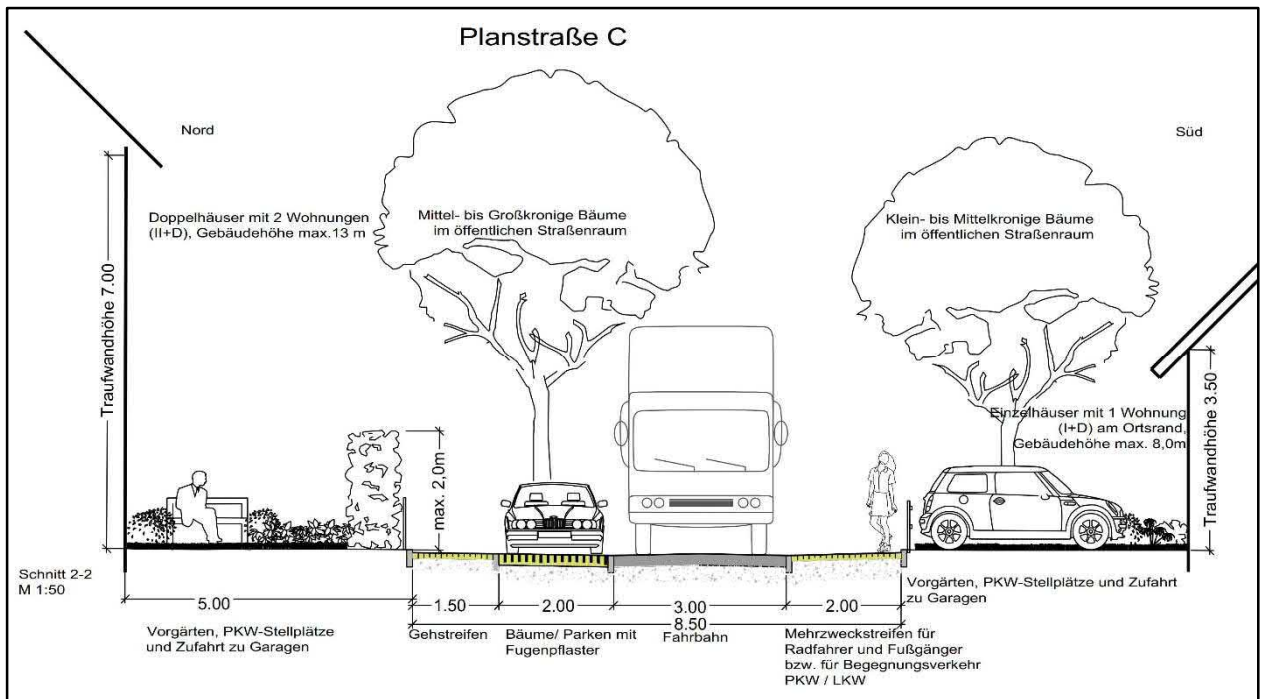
Straßenquerschnitt 8,5 m (Planstraße C)
